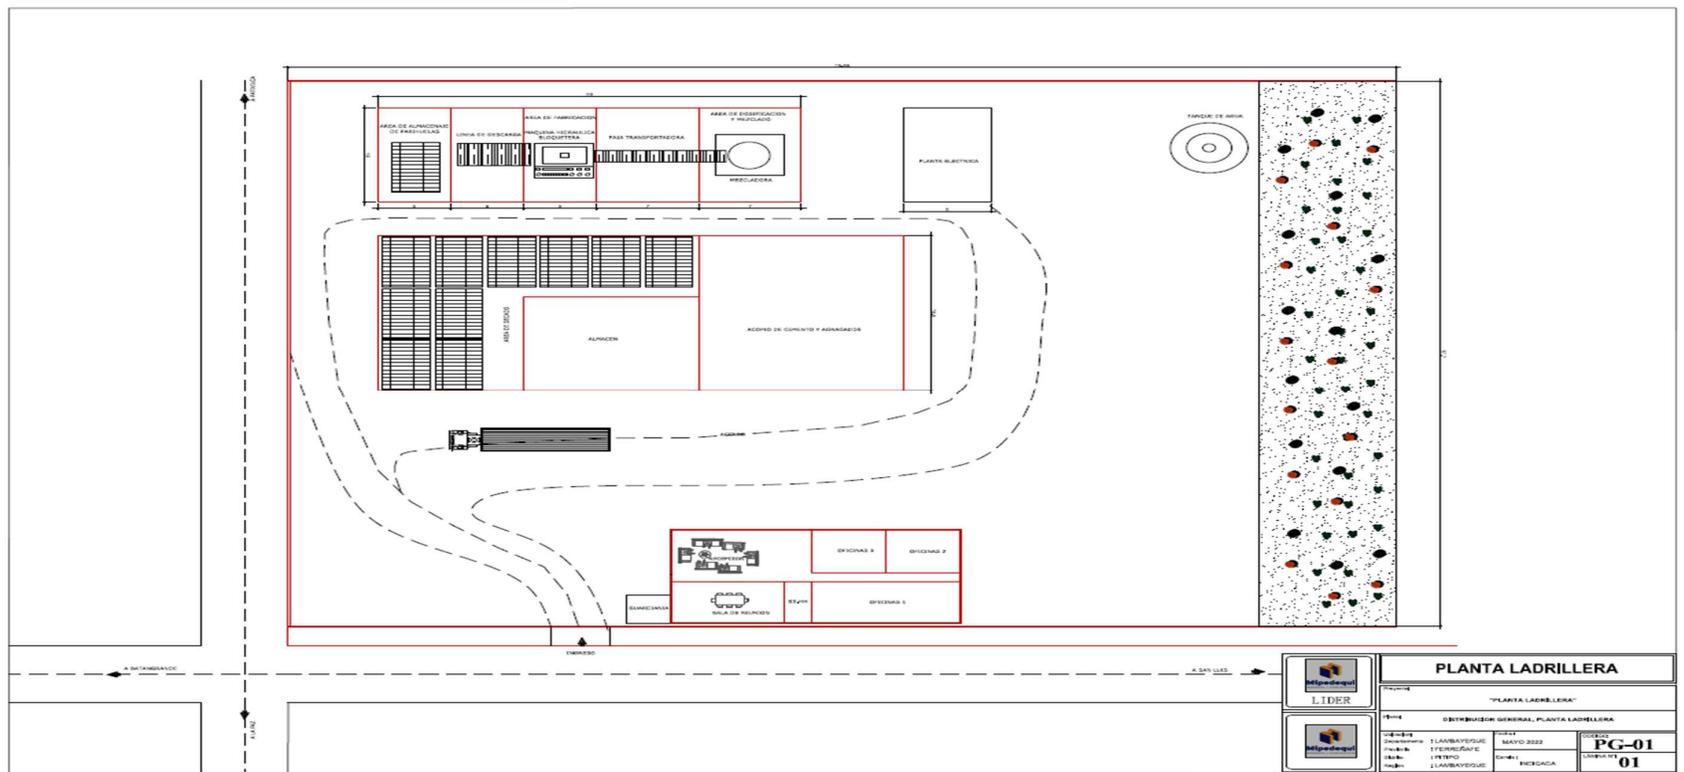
Distribución de la planta de producción de ladrillos de concreto.
